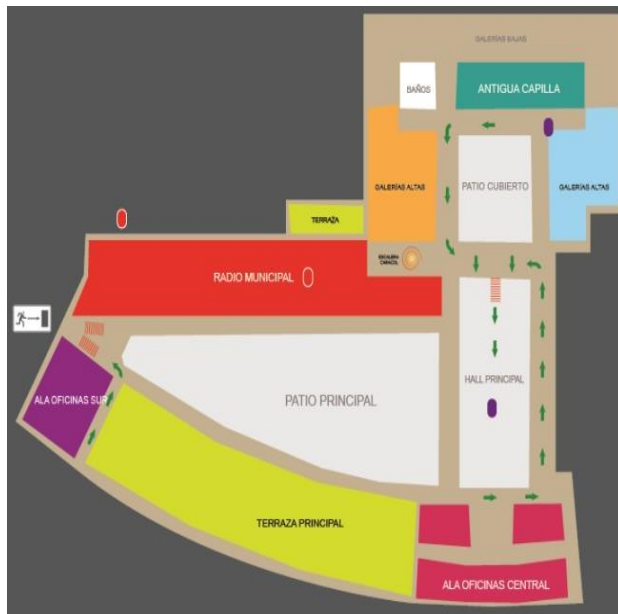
Planta Alta Centro de arte contemporáneo
